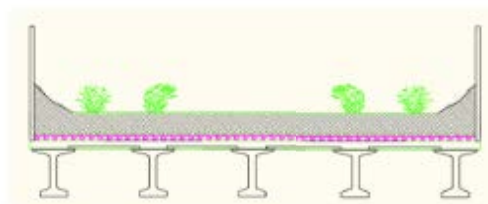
Esquema de puente tablero. (Fuente: Trabajo de fin de grado de Javier Barreda Redondo).
